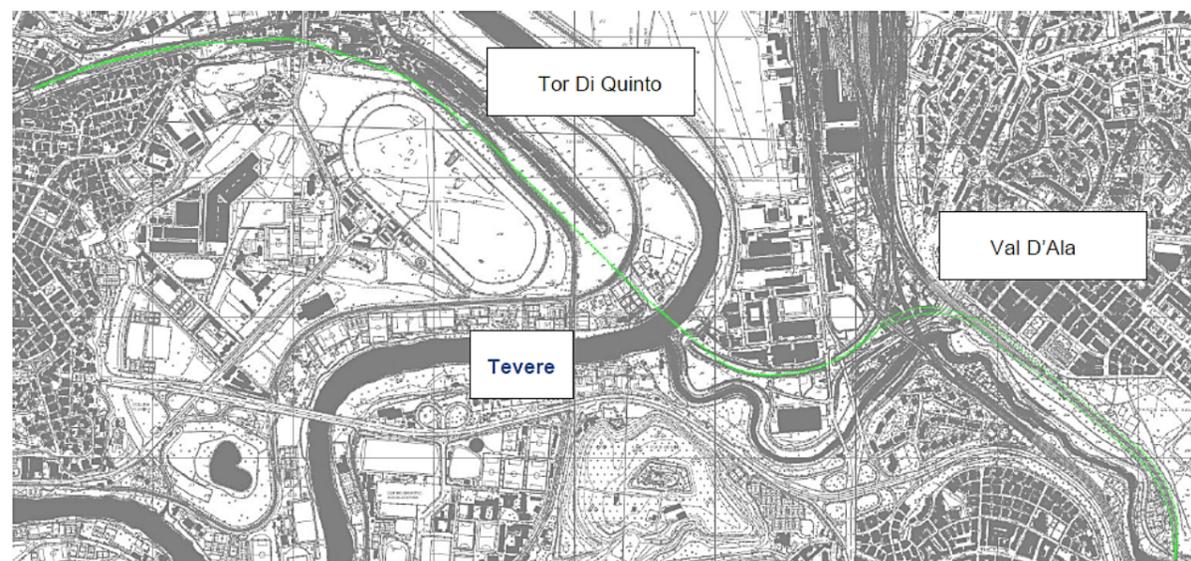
Planimetria e profilo dell'alternativa in galleria
